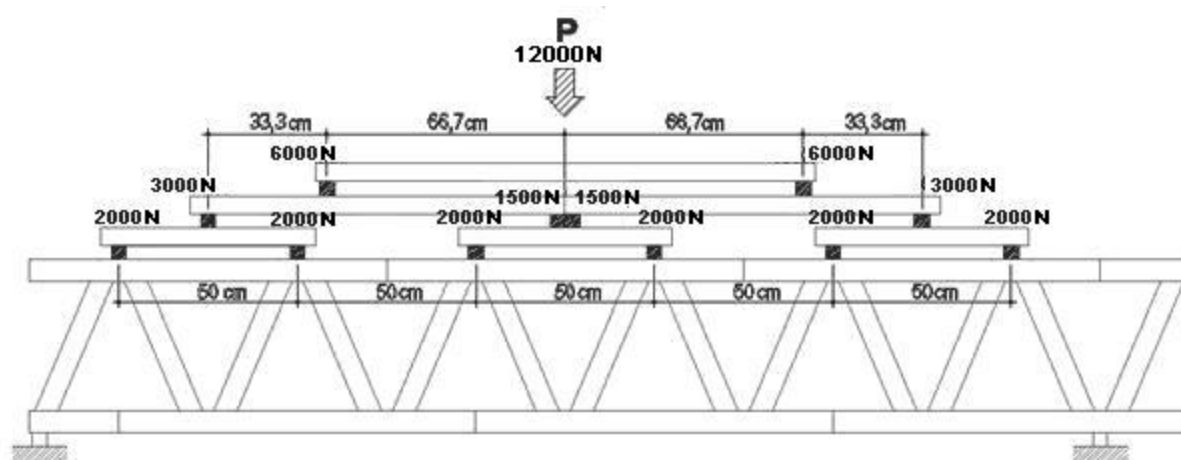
Sistema de barras para distribuição uniforme das cargas aplicadas.
